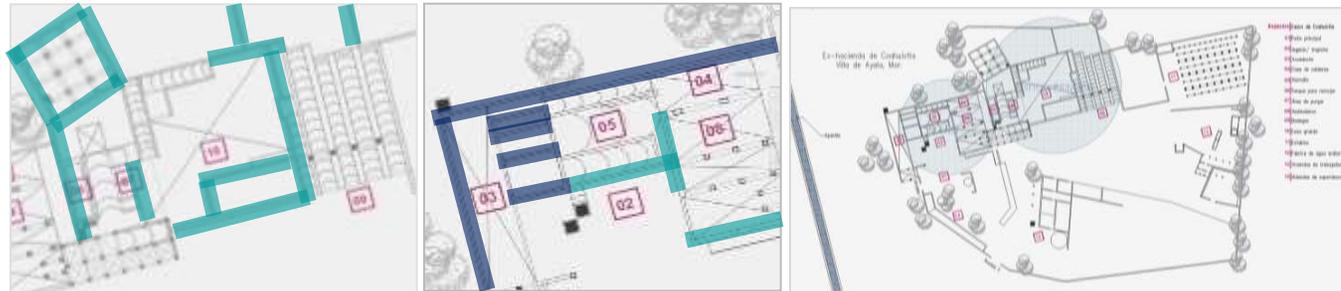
Zonas donde se identifican la tipología de muros de mampostería
